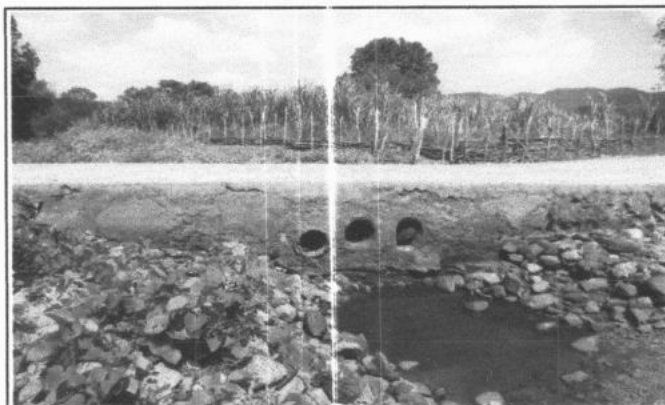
VISTA LATERAL PASSAGEM MOLHADA
